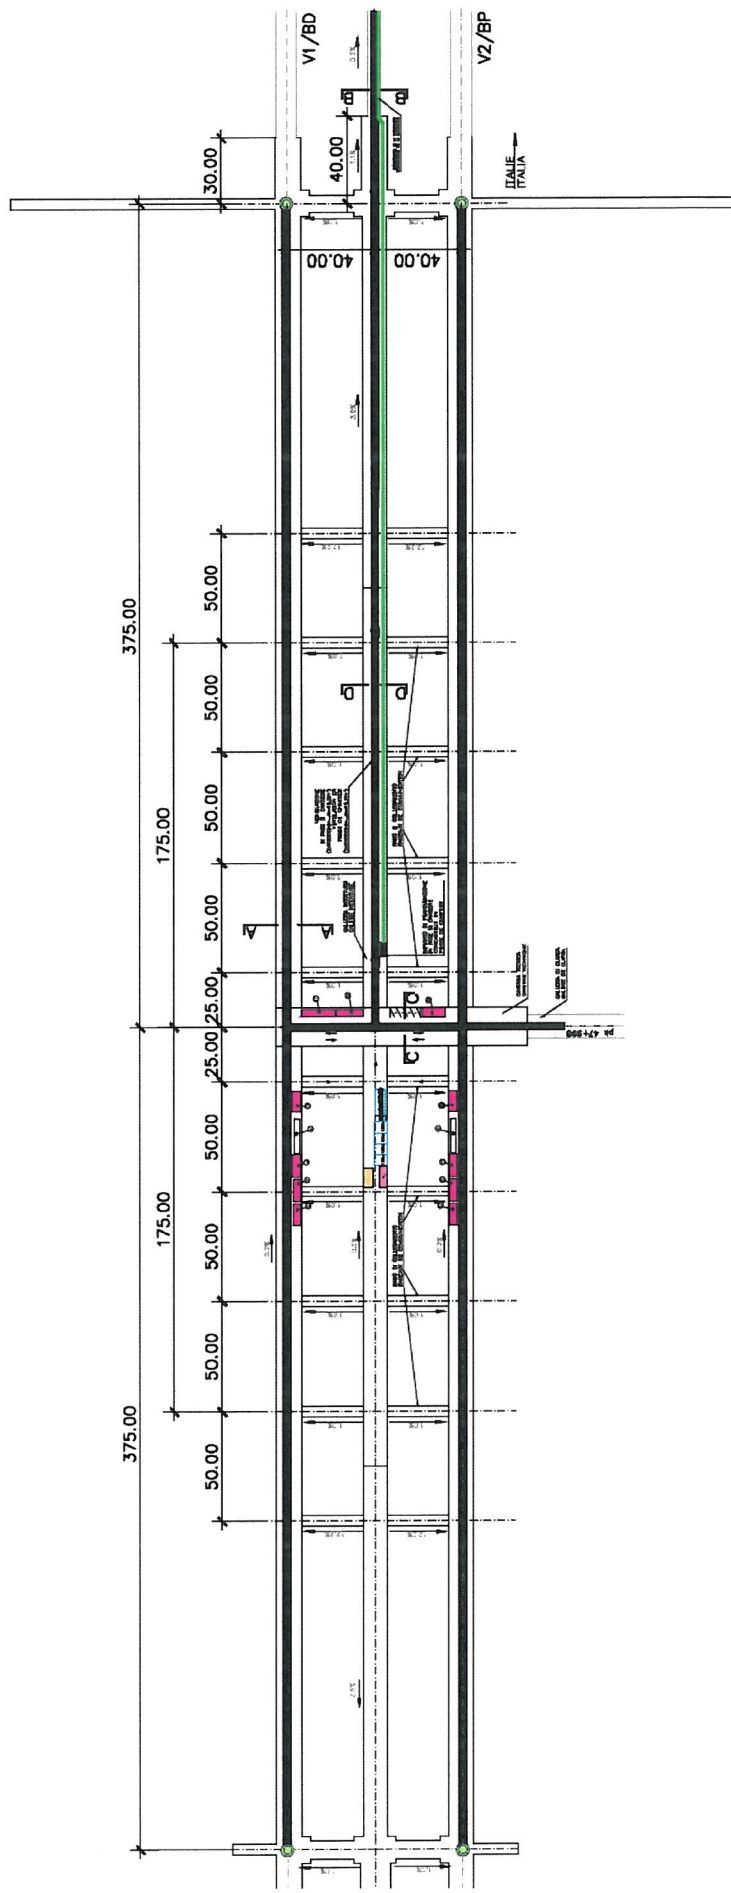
Planimetria dell'area di Clarea in fase cantiere
